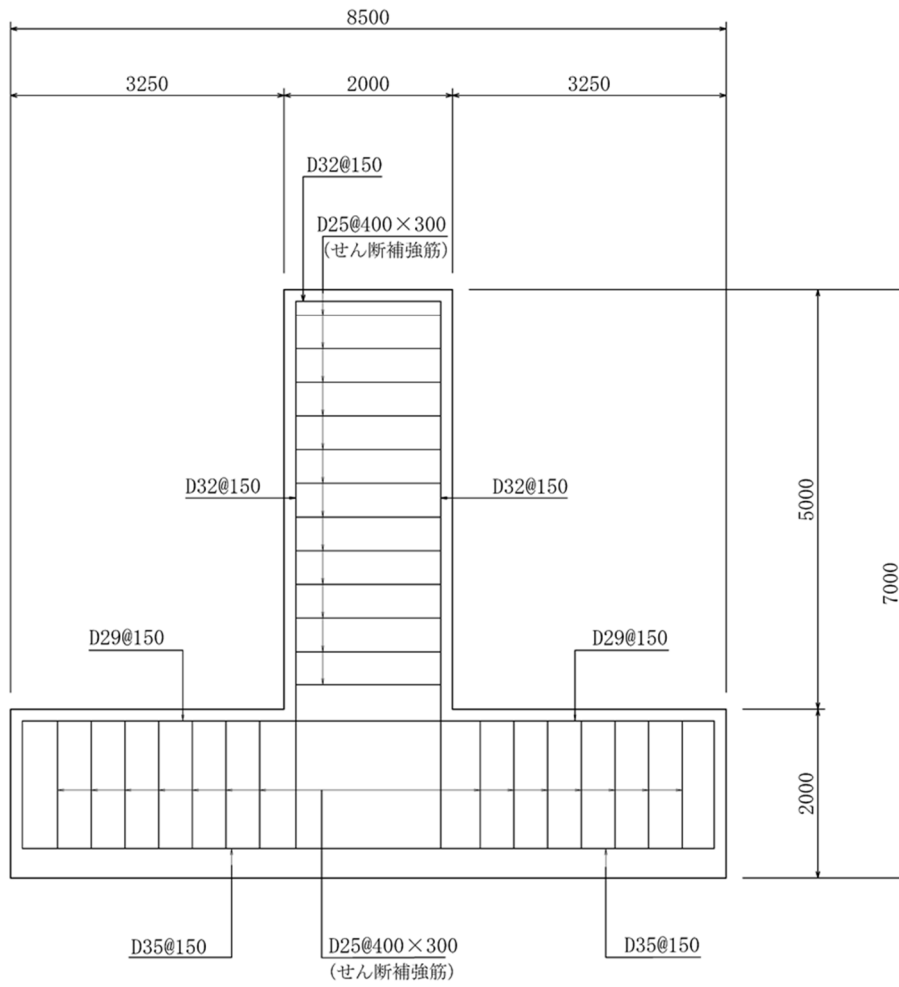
防波壁（逆 T 擁壁）の概略配筋図
